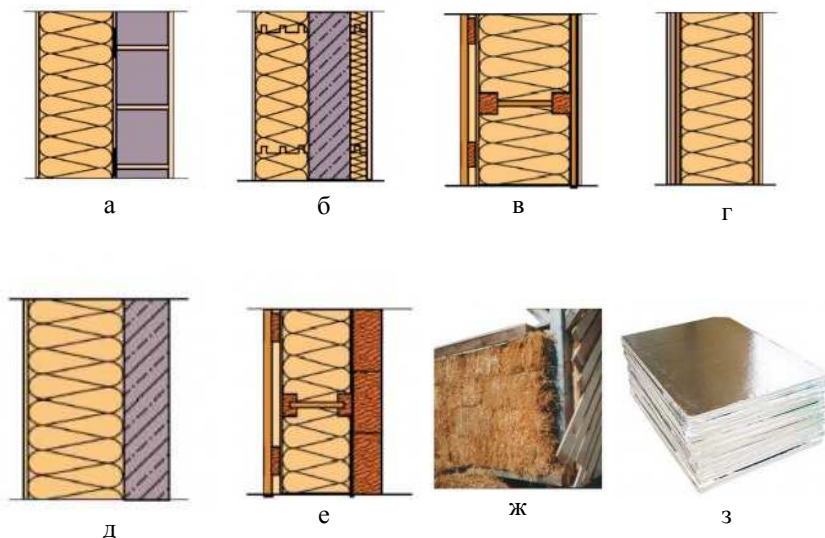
Конструкции наружных стен: а – стена из кирпичной кладки с системой наружного утепления более 25 см; б – опалубочный элемент из плотного пенополистирола (24 см); в – легкий стеновой элемент и каркас из деревянных или двутавровых балок + теплоизоляция (30 – 40 см); г – готовые строительные стеновые конструкции из пенополиуретанов, сэндвич-панелей (20 см); д – готовые блоки из легкого бетона с интегрированной теплоизоляцией; е – блочная шпунтовая дощатая стена; ж – стена из соломенных тюков (60 см); з – хай-тек: вакуумная изоляция (2,5 см)
